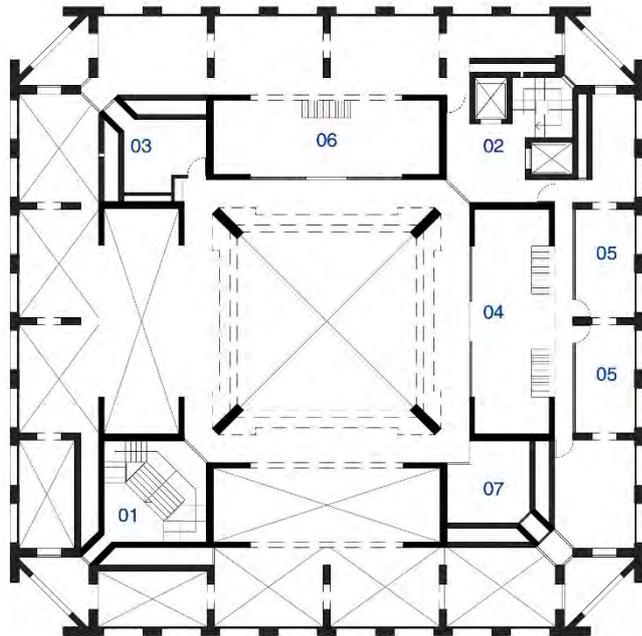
| Planta do terceiro pavimento (mezanino) [redesenho do autor]
